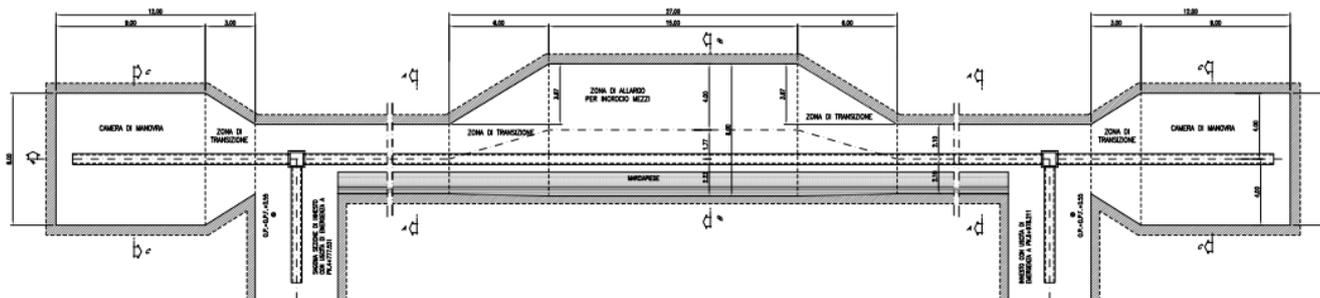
planimetria rettificata del cunicolo di sfollamento con indicazione delle zone di allargamento e delle uscite di emergenza
